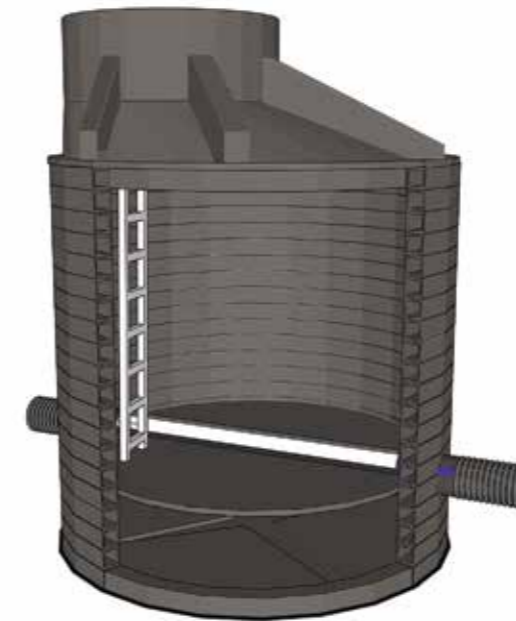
Типовой сварной канализационный колодец FD SVT
